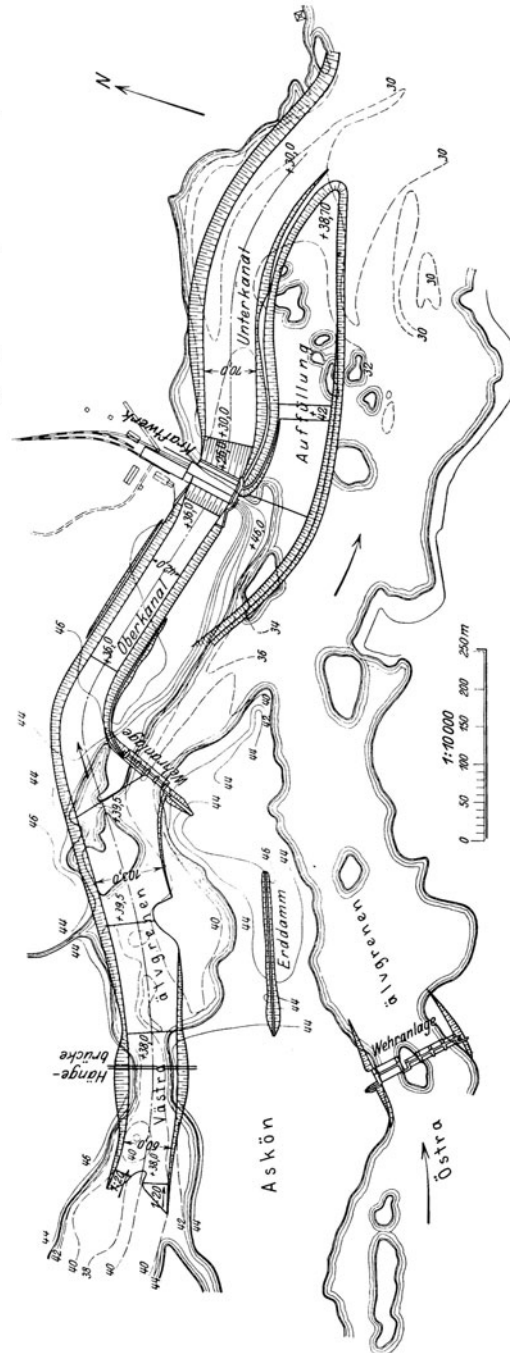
Lanforsen. Lageplan. (Vattenb.-Byråen.)
